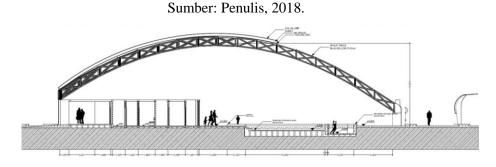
14 Potongan Bnagunan A-A (R. Lapangan Basket dan Futsal)
